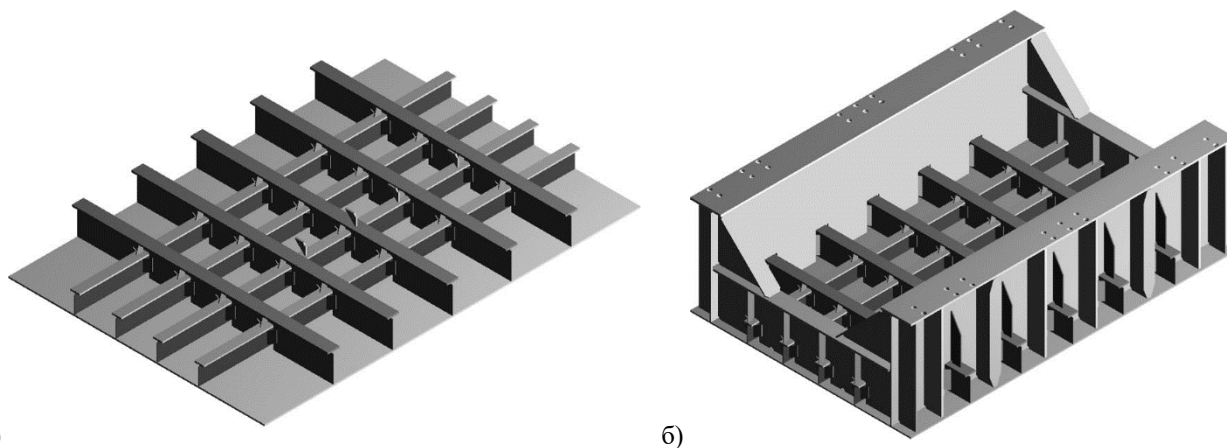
Оптимизированная конструкция перекрытия ледового пояса МЛСП (вид изнутри): а) наружная обшивка и набор; б) перекрытие с опорным контуром
